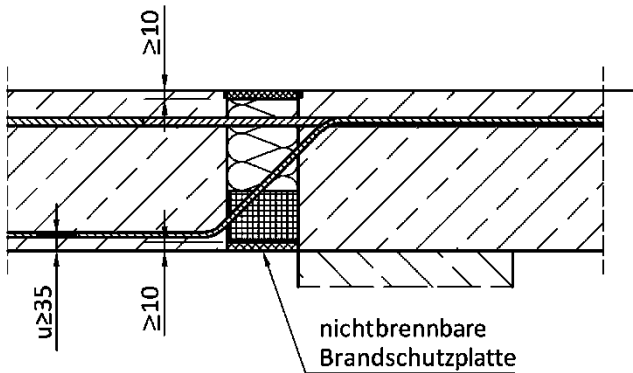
Ausführung ISOPRO Typ M Q mit integrierte in Bauteilebene durchgehende nicht brennbare Schicht nach Abschnitt 2.1.3 (exemplarisch mit CCB)
